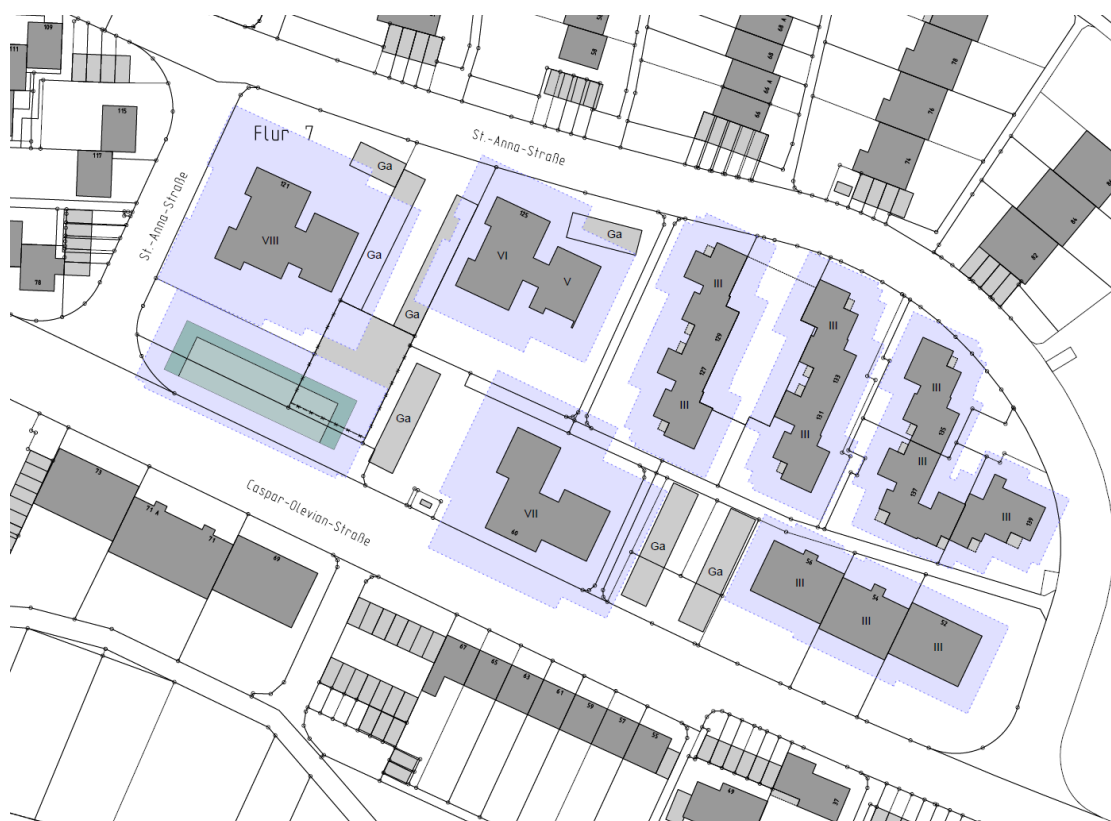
Gebäude zwischen Caspar-Olevian-Straße und St.-Anna-Straße mit Abstandsflächen (lila Flächen)
